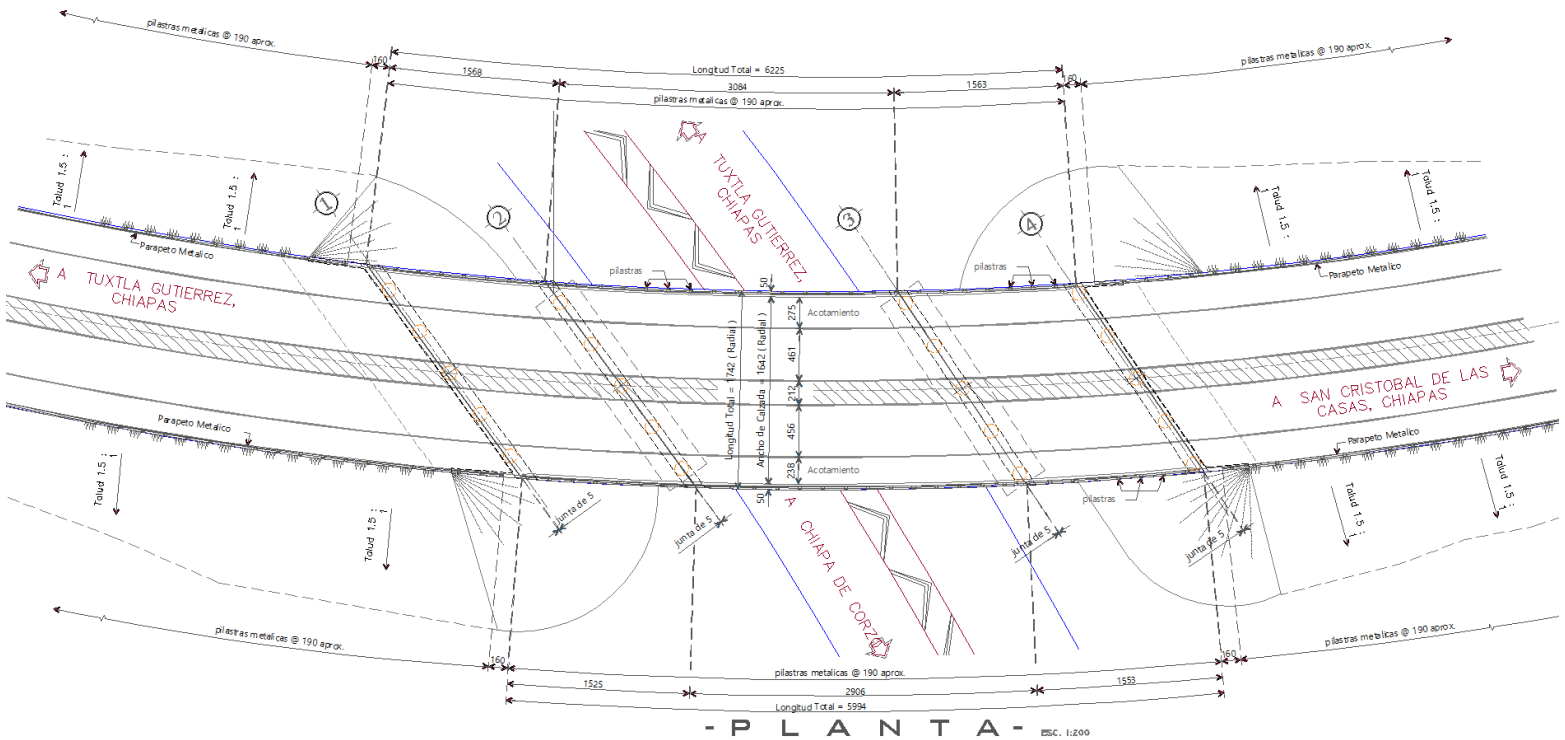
Vista en planta del PSV del kilómetro 000+500, Tuxtla Gutiérrez – San Cristóbal.
